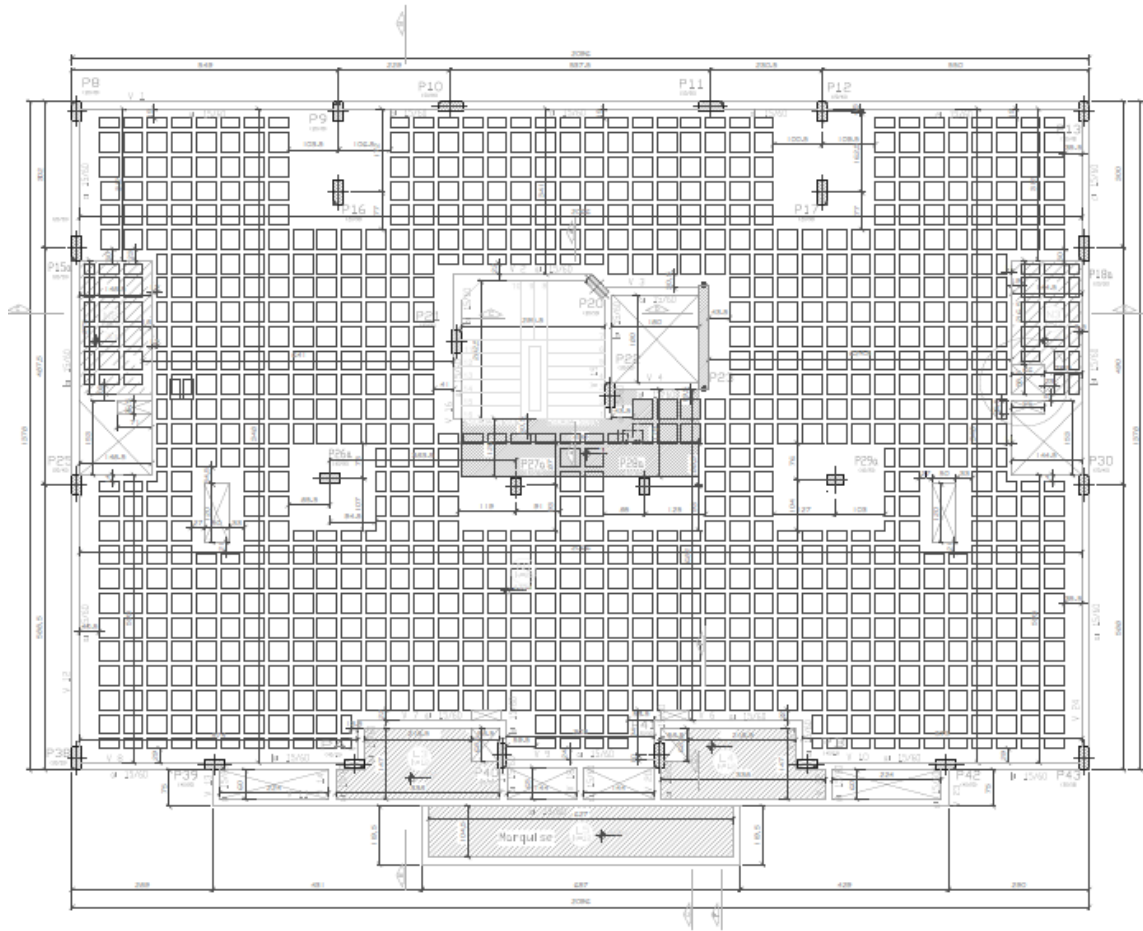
Projeto de arquitetura – Planta baixa de térreo.
